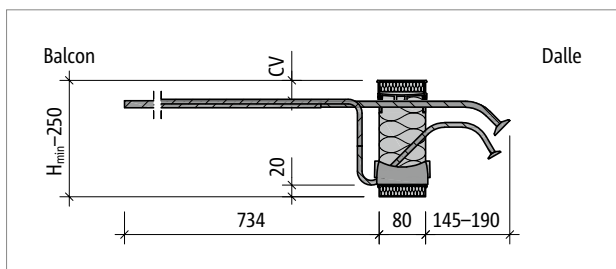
Schöck Isokorb® T type K-O-M2 : coupe du produit
